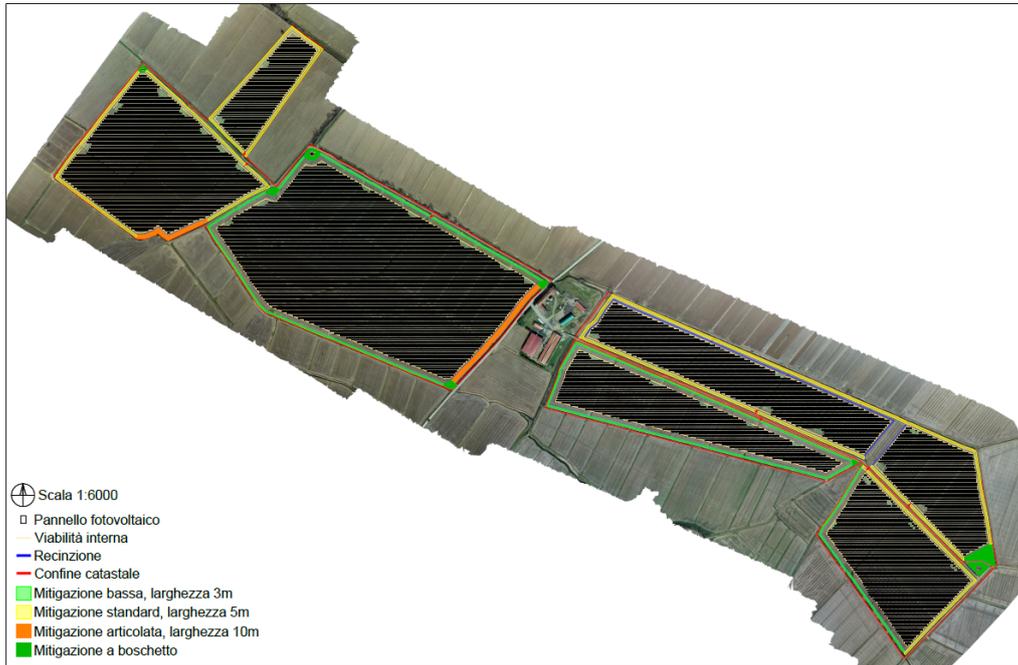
d: Planimetria impianto fotovoltaico di riferimento
